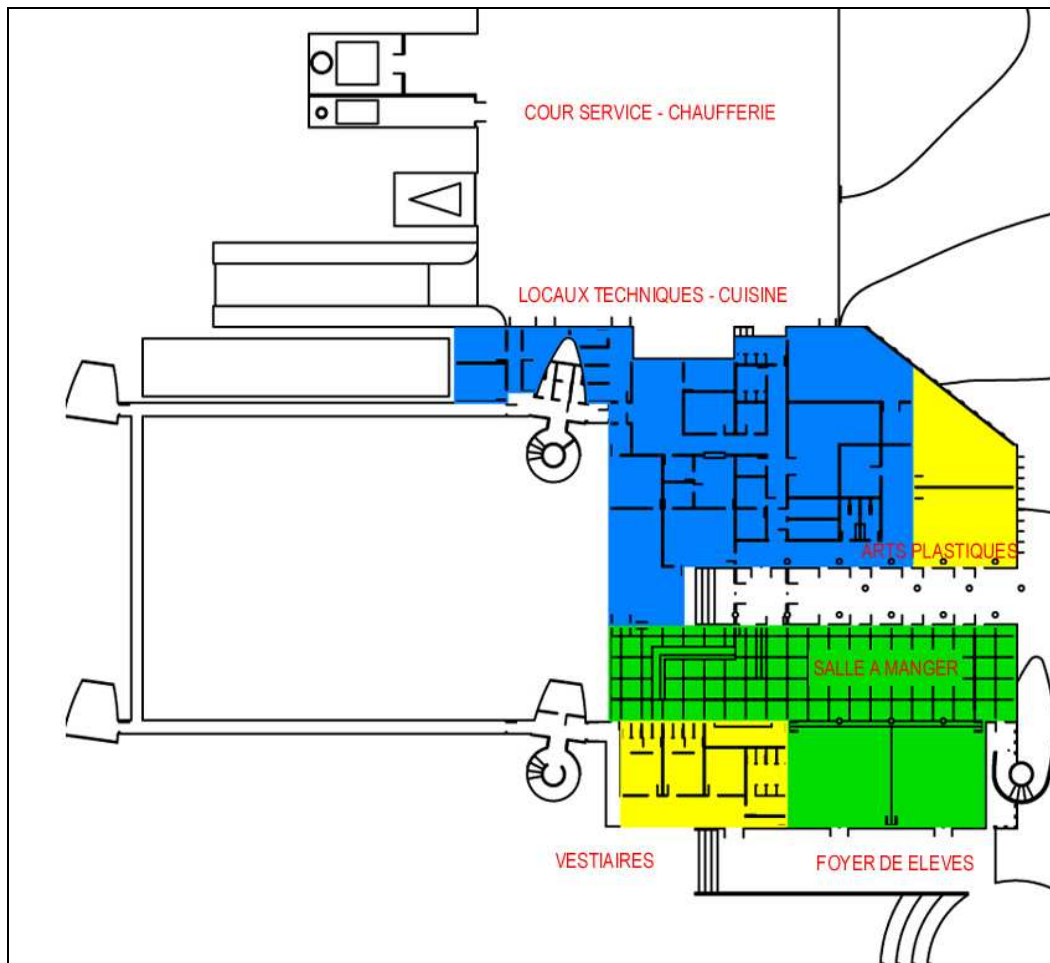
Collège Guy Dolmaire, plan R-1.
